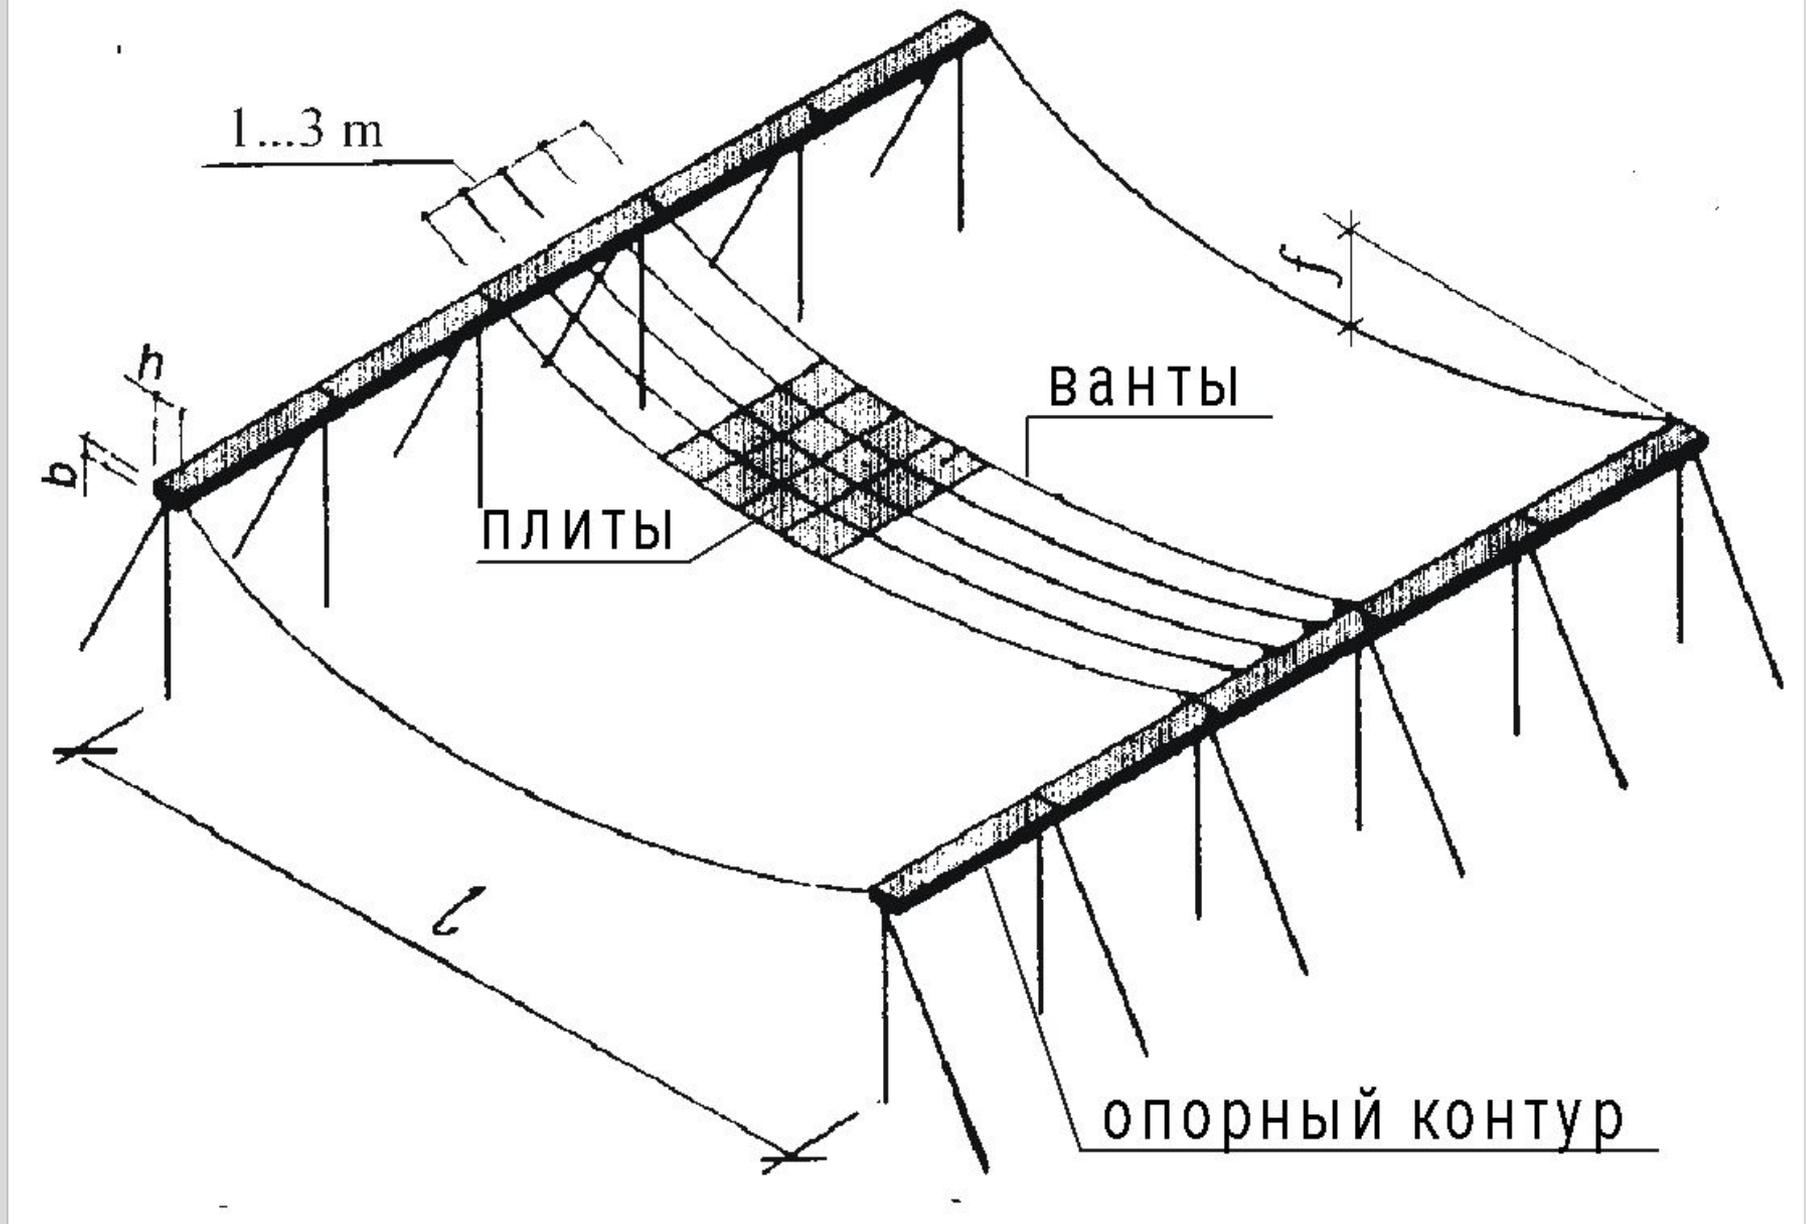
Схема однопоясного покрытия прямоугольного в плане
